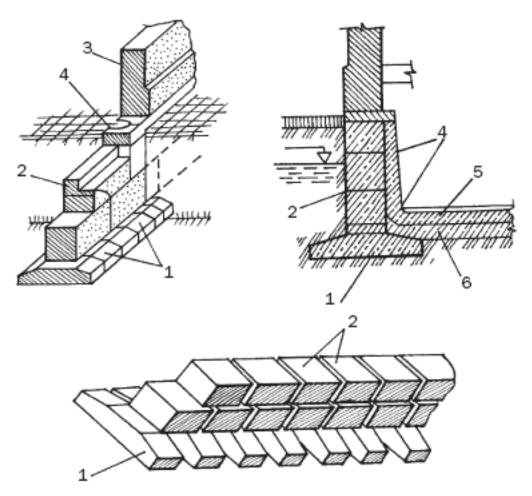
Расширение площади основания фундамента: 1 – железобетонная подушка; 2 – фундаментные блоки; 3 – цоколь; 4 – гидроизоляция; 5 – железобетонные плиты; 6 – бетонная подготовка
